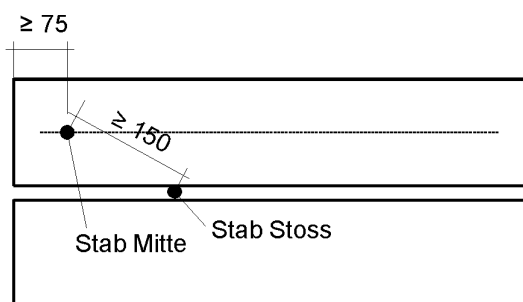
Beschussorte im Grundriss (Masse in Millimeter)
